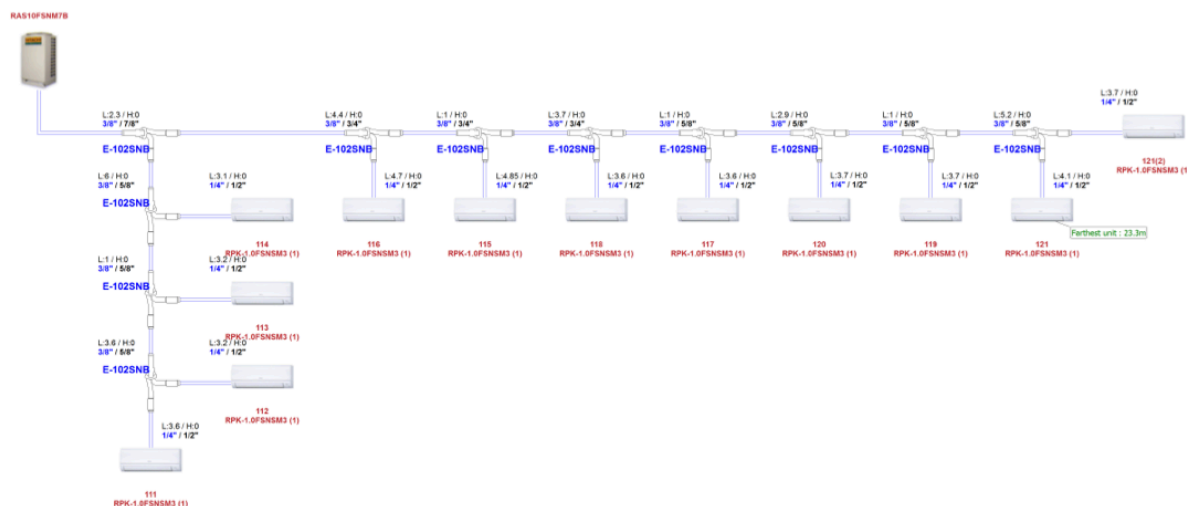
Esquema das tubulações do pavimento tipo (Fonte: Autor, 2015)
